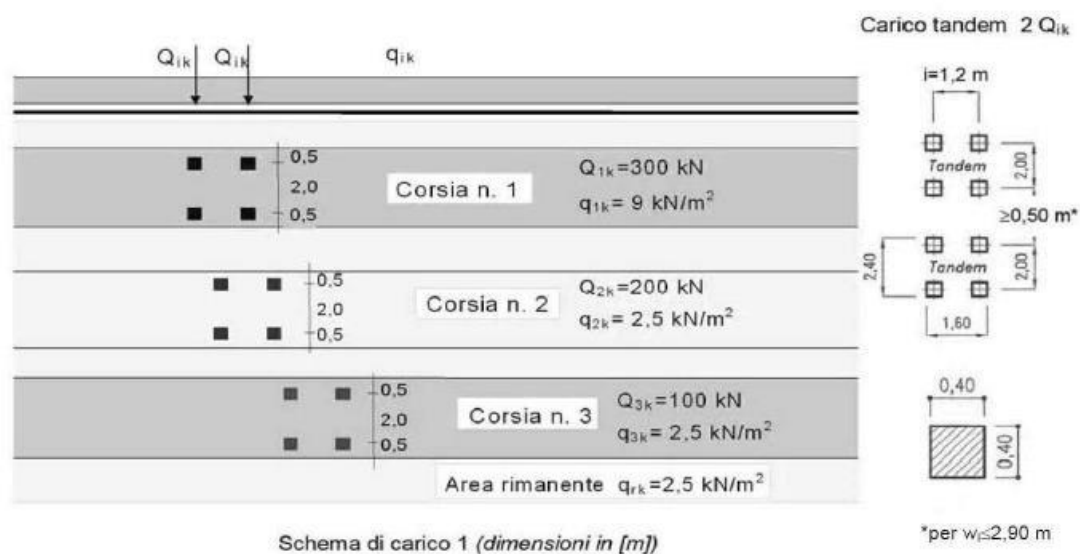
Schemi di carico su ponte stradale secondo D.M. 17.01.2018
